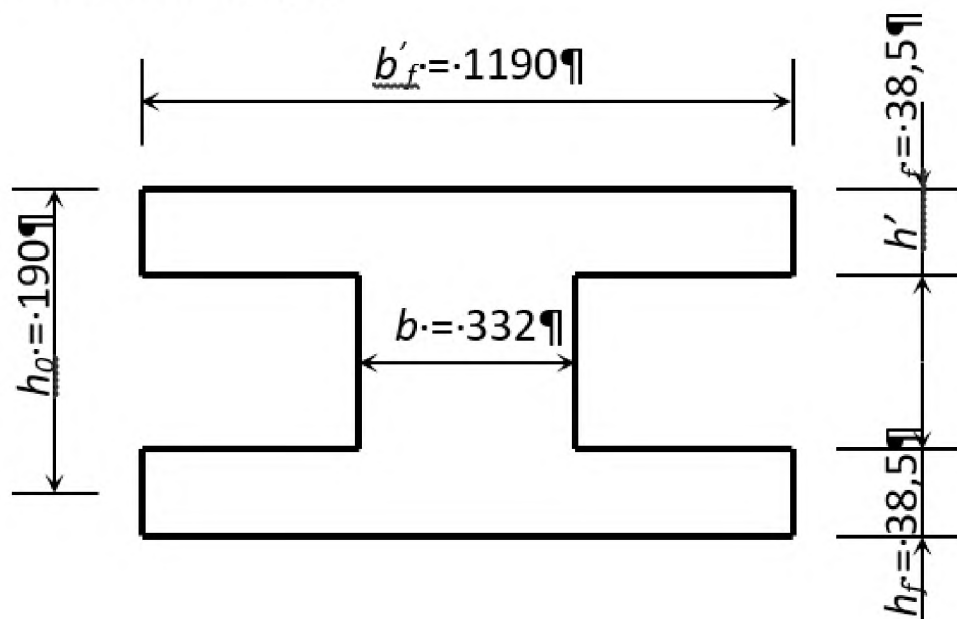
Розрахунковий переріз плити перекриття
